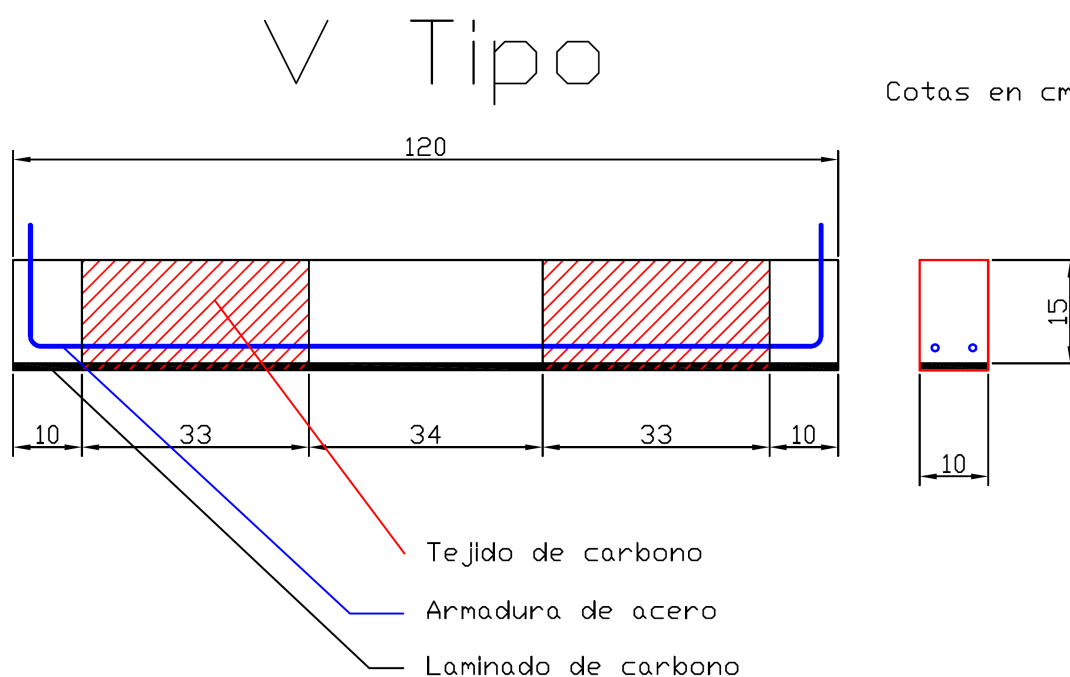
Viga tipo con sus armaduras y refuerzos de carbono.
